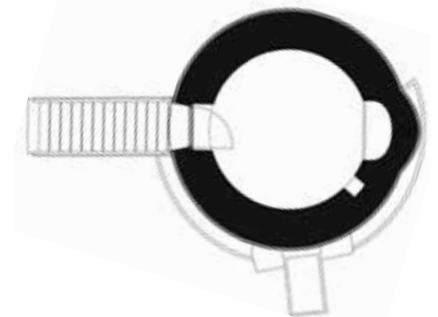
Grundriss Geistthal, M1:200. TU Graz/Jagersbacher, Weissberg 2008.
